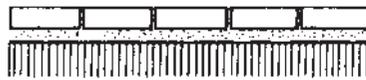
Disposición tizón en plano con junta estrecha (aprox. 3 mm).
